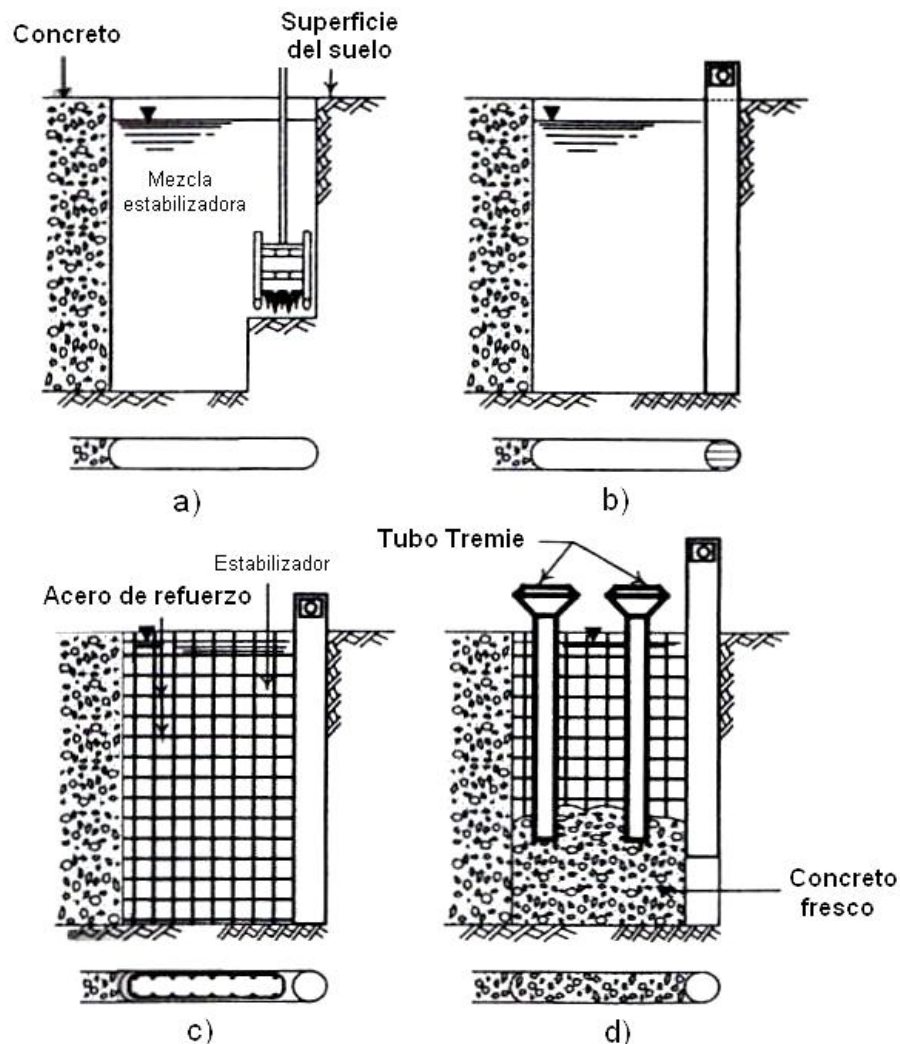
Proceso constructivo de muros diafragma (Puller, 1996).
